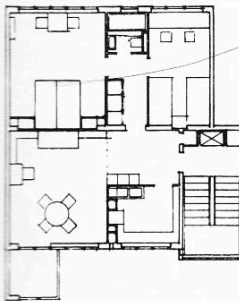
Vivienda sin pasillo con 4 camas y emplazamiento prefijado de la glorieta. Proyecto: Arq. A. Klein. La planta ha sido proyectada en base a la ordenación y espaciosidad de las piezas. 1) Subdivisión de la planta en dos áreas principales: zona de día y zona de noche. 2) Sala de estar y recibidor forman un mismo ambiente, existiendo la posibilidad de separación entre ambos mediante una cortina o una puerta acristalada. 3) Reducción de la cocina en favor de la sala de estar. 4) Incorporación a la zona de noche de un espacio para armarios empotrados que pueden ser iluminados mediante la utilización de una puerta acristalada. 5) La posición de la glorieta, que se ha fijado a priori, provoca un asoleo irregular en la sala de estar. 6) Disposición de las camas en la parte más interior y consecuentemente más silenciosa del dormitorio (ausencia de corrientes de aire). 7) Las superficies libres se encuentran hacia el exterior, y son bien iluminadas. 8) Colocación del mobiliario de forma concentrada (ausencia de objetos altos adosados a las paredes). 9) Posibilidad de instalación de un ascensor.
